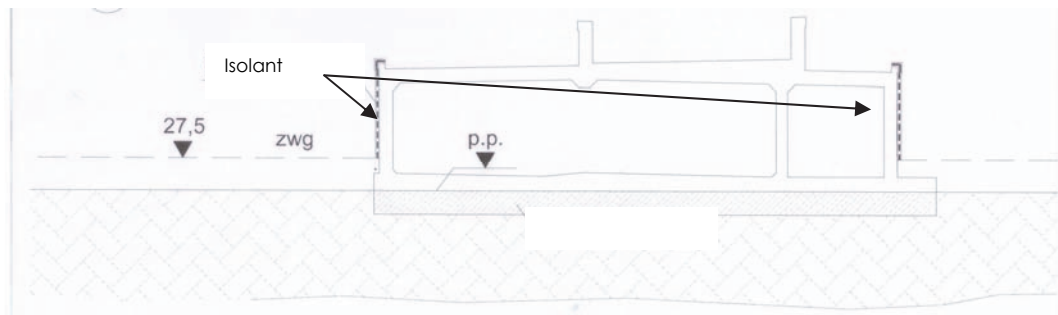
Mise en place de l'isolation extérieure des parois du tunnel.
